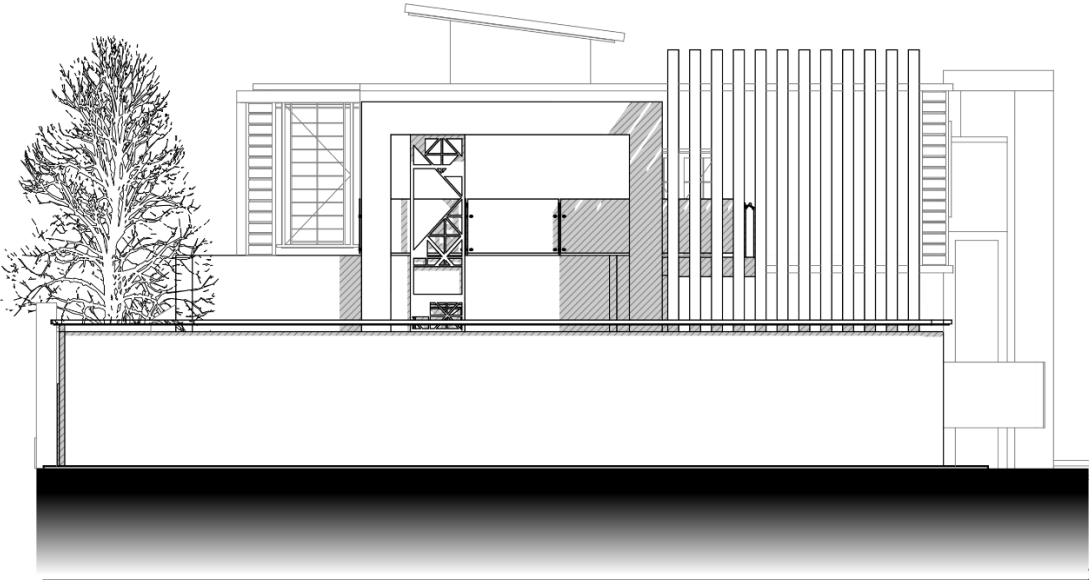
Façade latérale 2 avec clôture ech 1/100.
